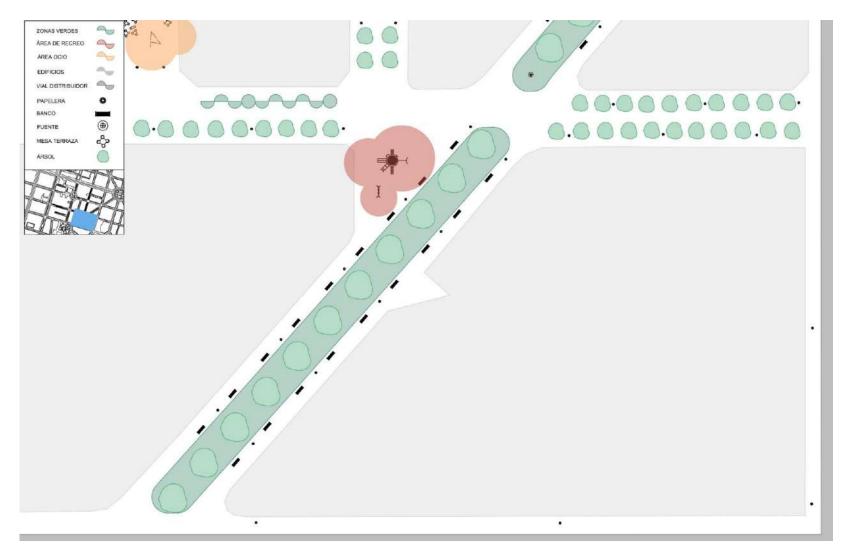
Plano de detalle 6. Escala 1:500 (A3).
